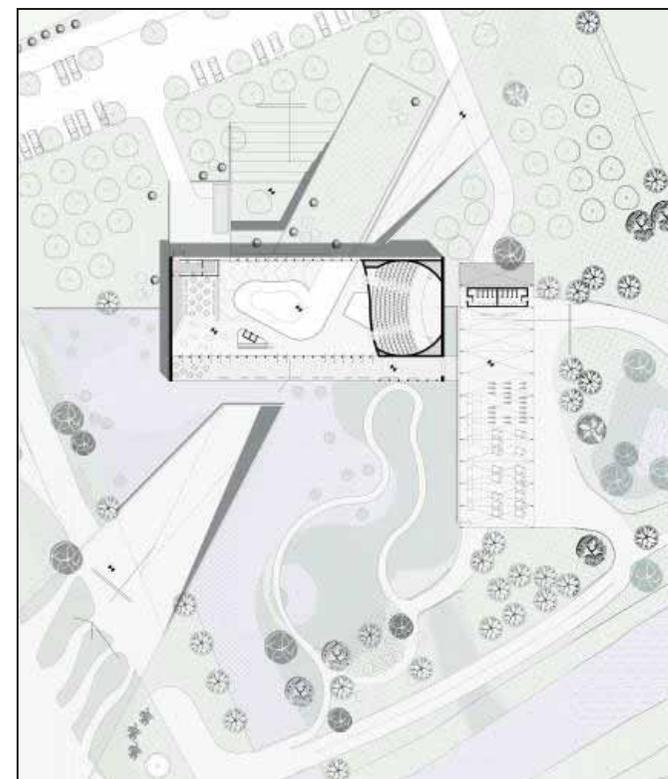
Planta Baixa- Primeiro andar com implantação. Fonte: <http://www.archdaily.com>
